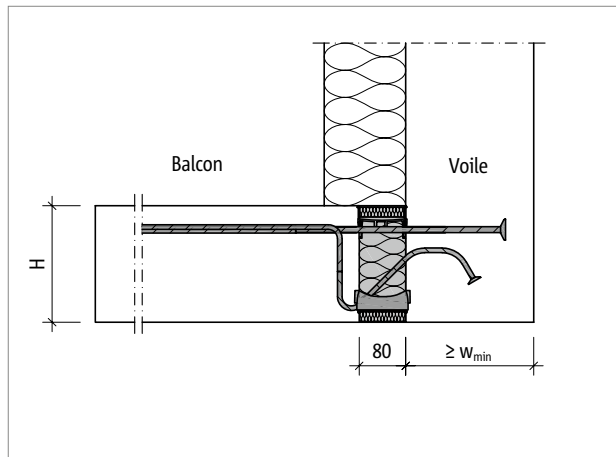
Schöck Isokorb® T type K-U : raccordement mural vers le haut avec isolation extérieure
